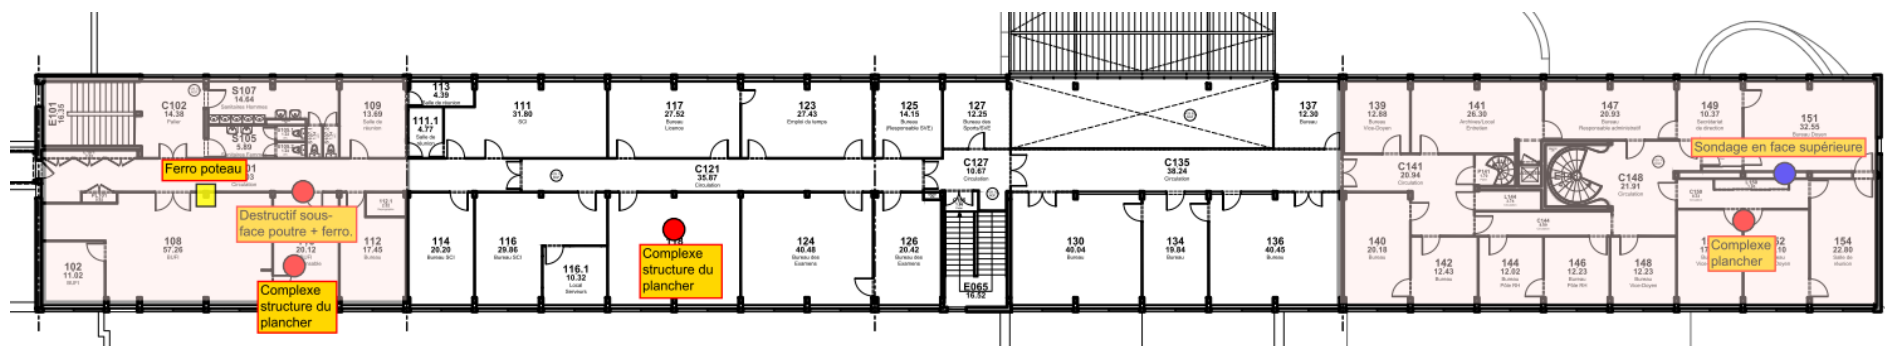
BATIMENT 1 – Plancher haut niveau 1
